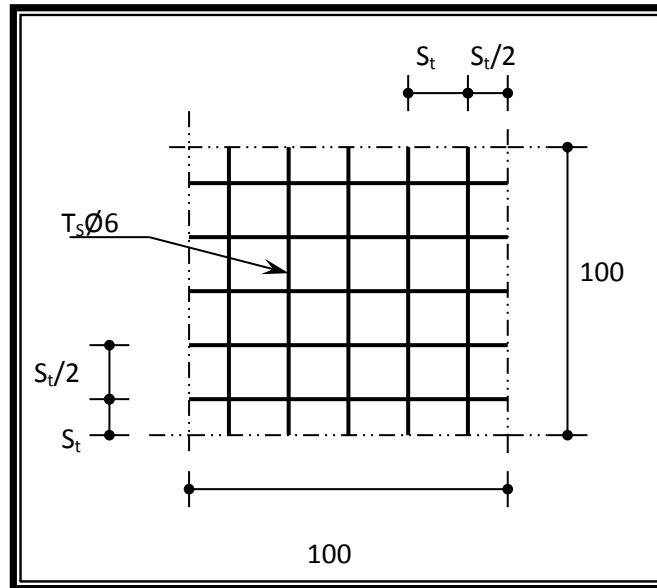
disposition constructive des armatures de la dalle de compression
